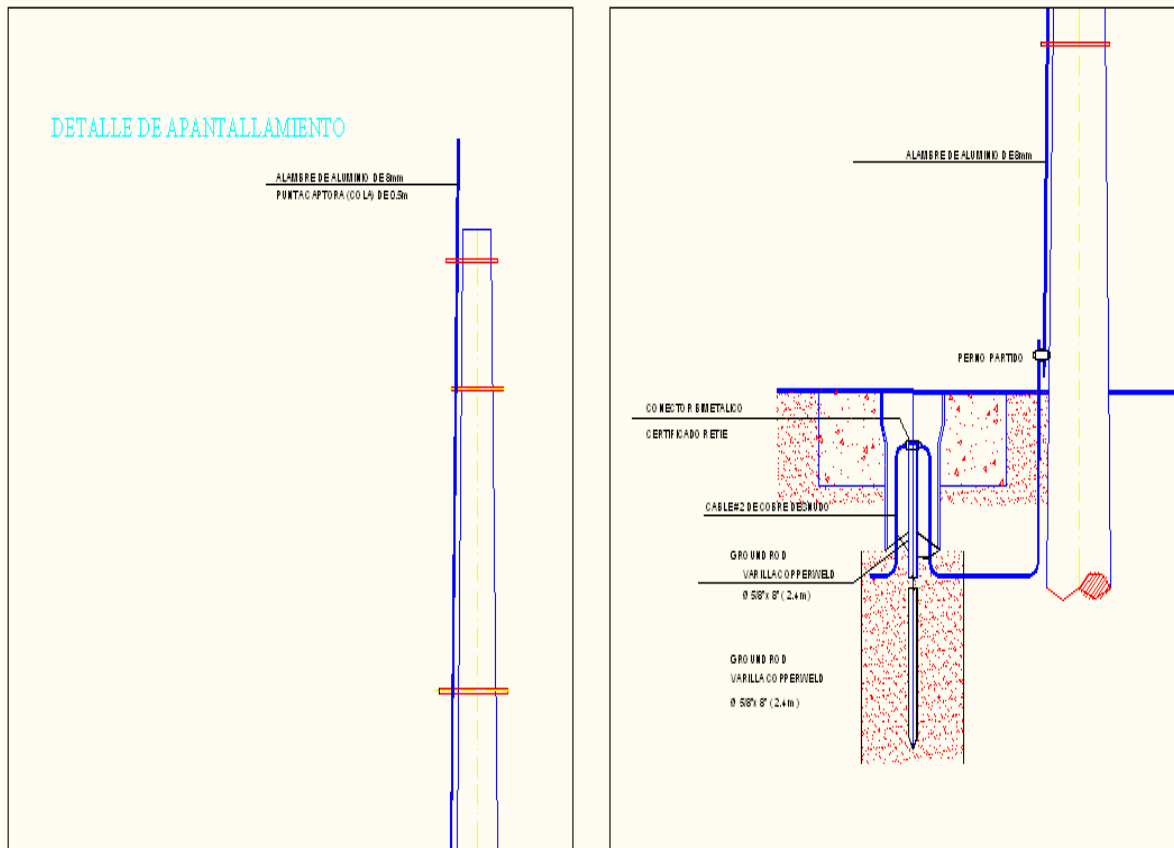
Detalle de montaje, instalación y conexión de puntas captadoras y bajantes en cada poste.
